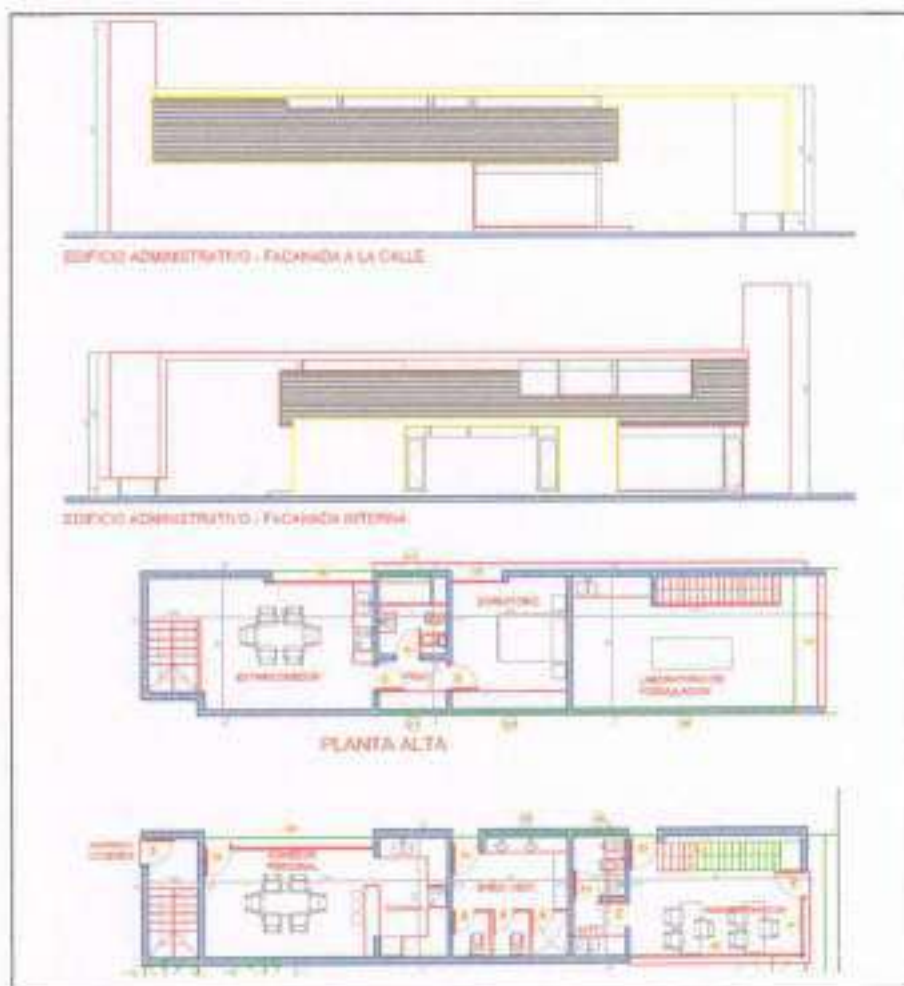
Vista frontal y en planta del Área de servicios de apoyo.
